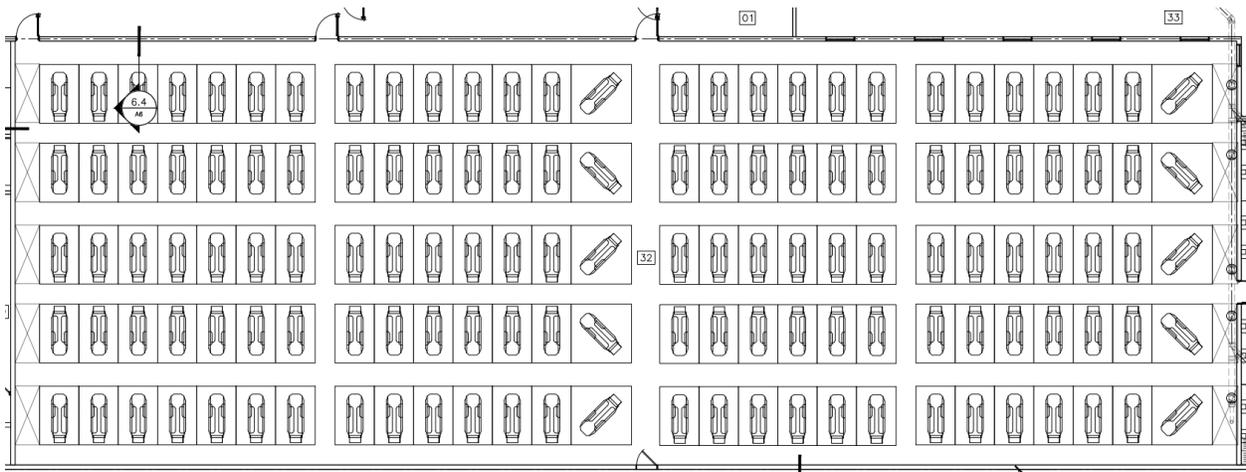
Plan de plancher de la salle de mise bas (63'-8" x 183'-10")
